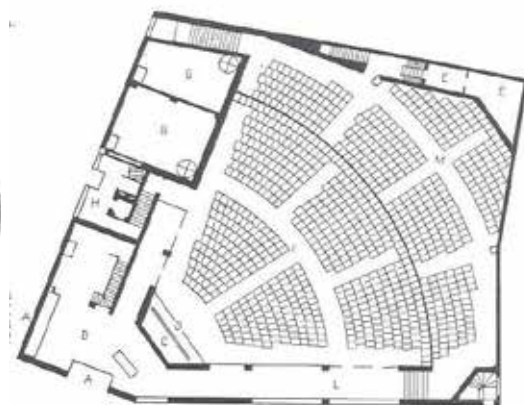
planimetria a ventaglio cinema a Milano, arch. Belgioso, Peressutti e Rogers
